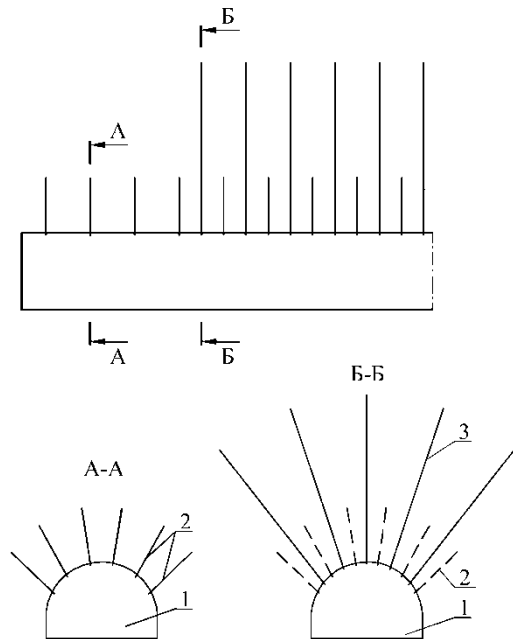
Схема комбинированного способа крепления выработки анкерной крепью: 1 – забой выработки; 2 – жесткая анкерная крепь; 3 – податливая анкерная крепь
